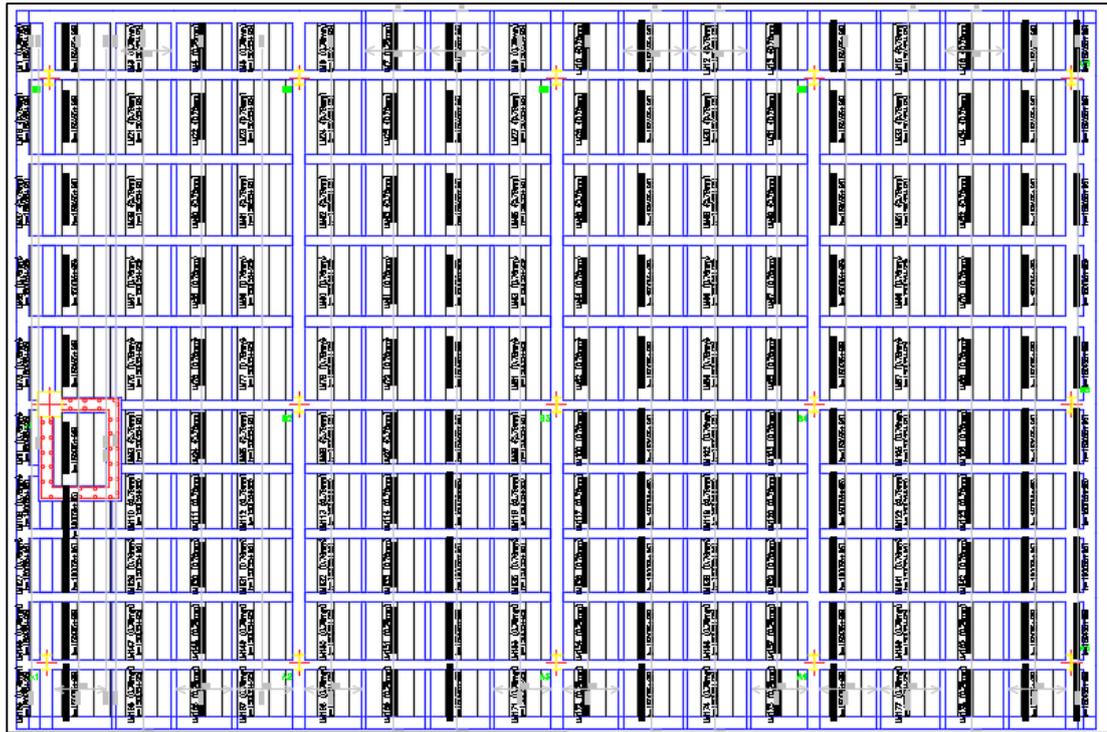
Esquema de la distribución de losa en planta N+1,62 (Acero)
